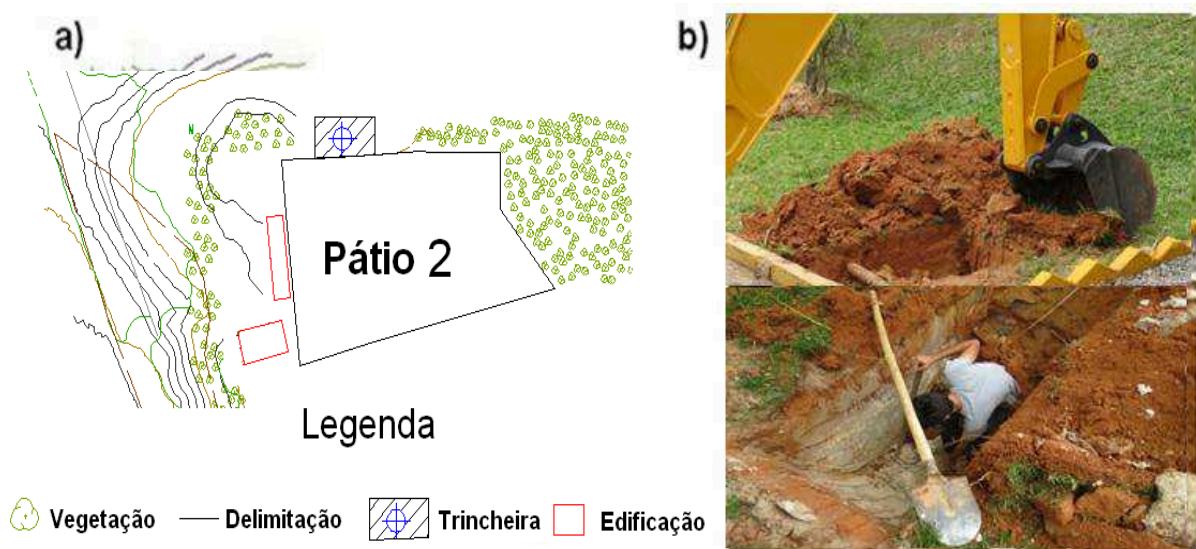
Visão geral da (a) Planta de localização e do (b) poço de sondagem.
